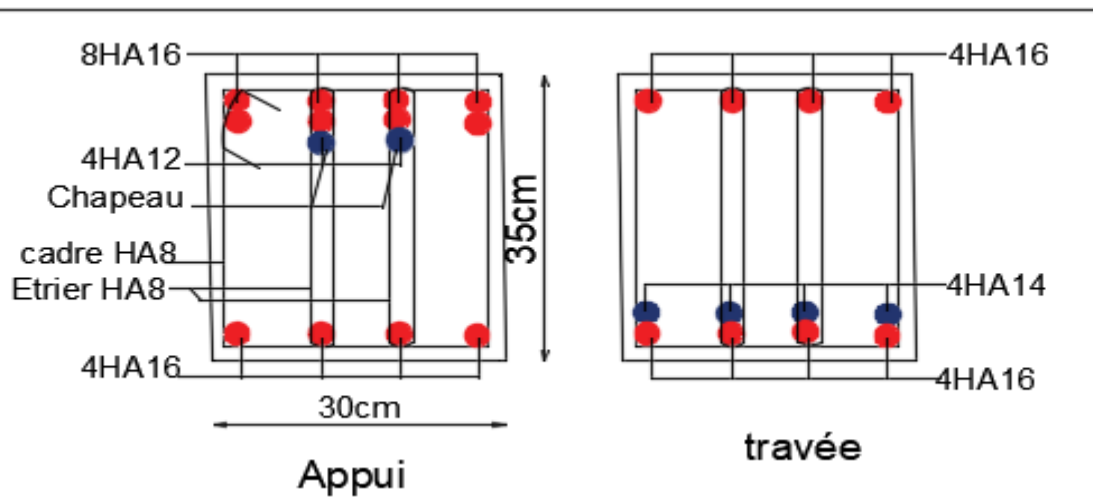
Schéma de ferrailage de la poutre secondaire du plancher étage 3
